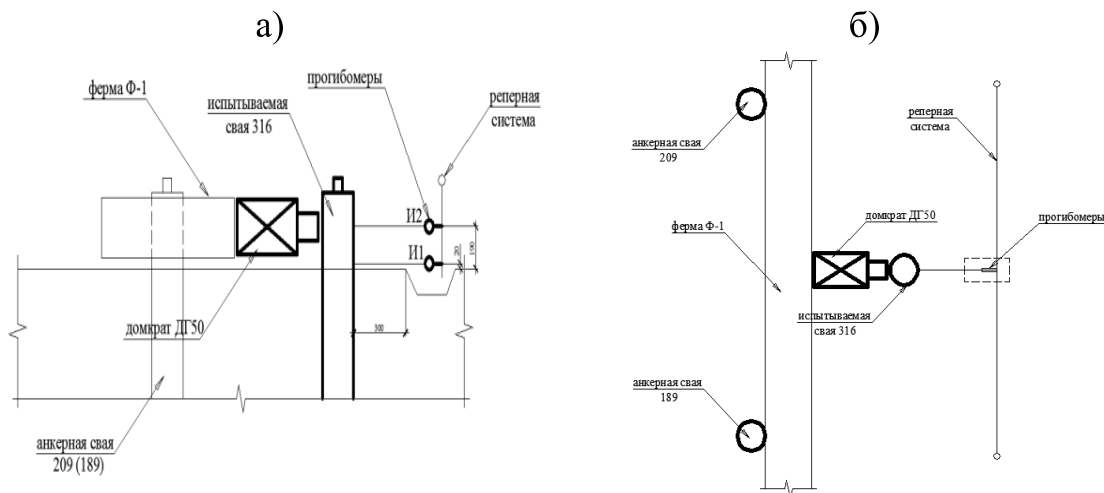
Устройство для испытания сваи на горизонтальную нагрузку:
